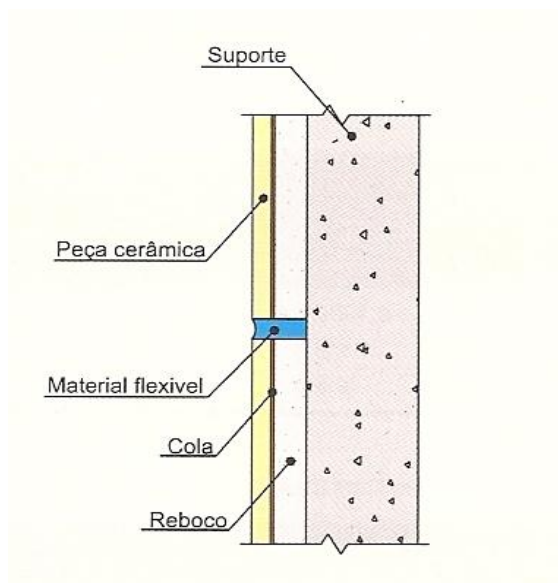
Exemplo de junta intermédia ou de esquadramento [2]
